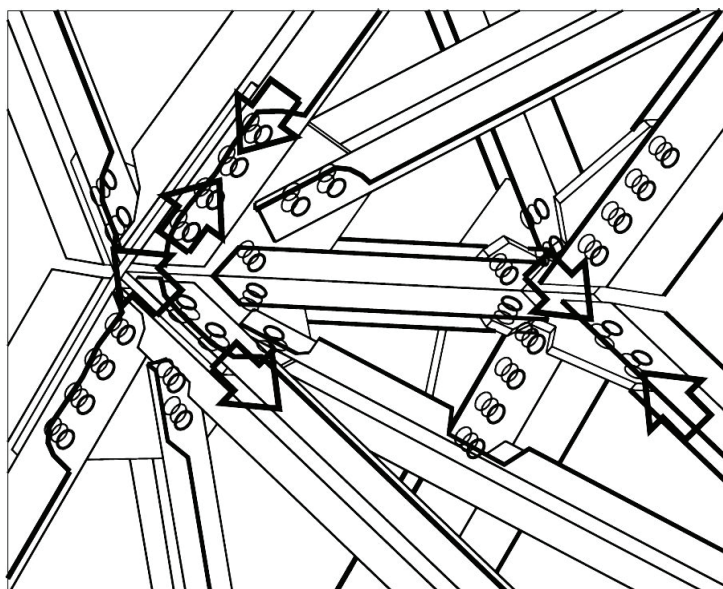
Соединение стержней из парных уголков к перекрестным фасонкам (стрелками показаны необходимые смещения для постановки болтов)
